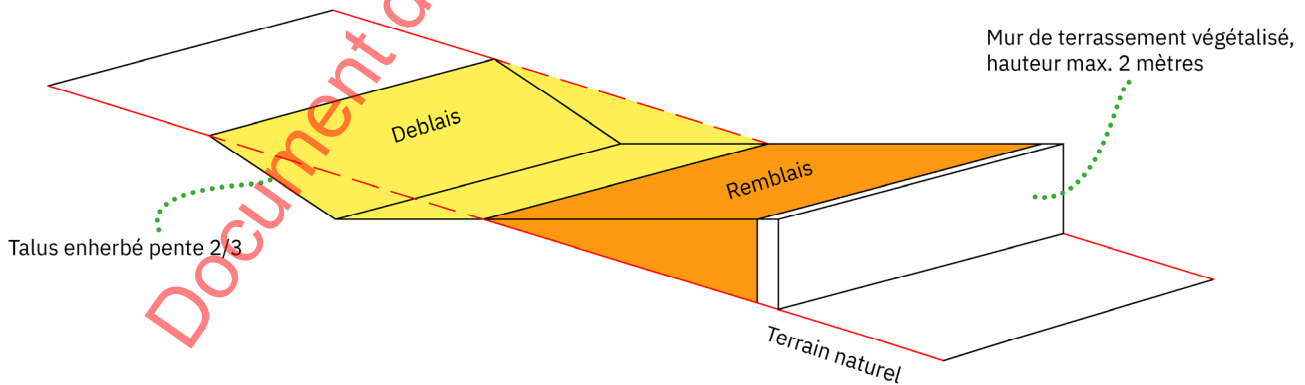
| Principe d'équilibre des déblais/remblais pour les terrassements
